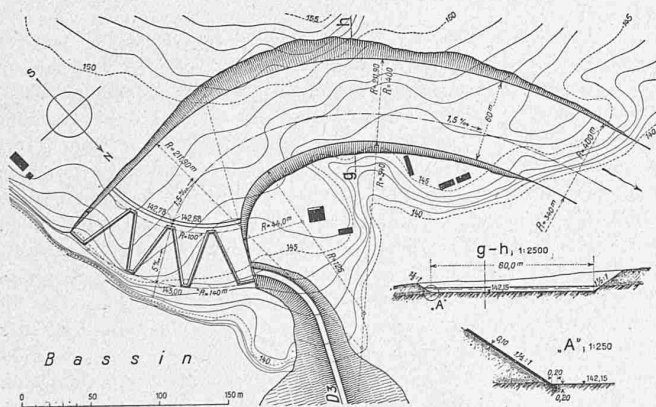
Ueberlaufwerk mit Ableitungskanal. — Lageplan 1:5000.
